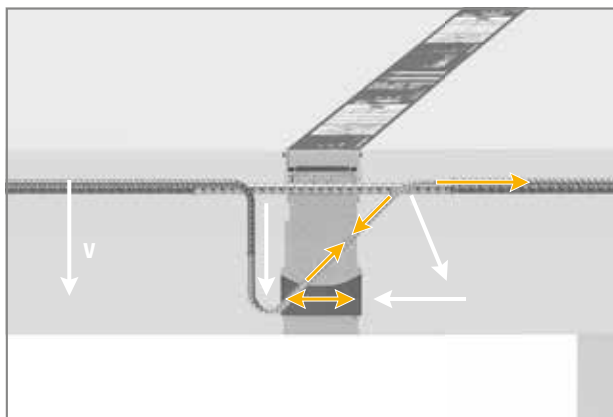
Schöck Isokorb® T tipo KL: trasmissione della forza di taglio
